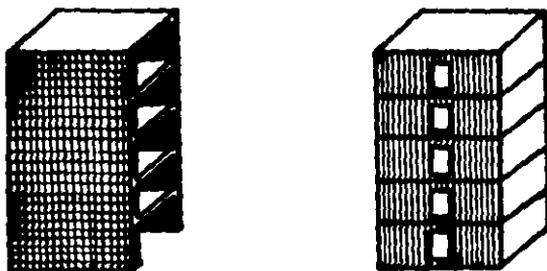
Sistemas de muros de cortante (Cap.3, Ref.1)
